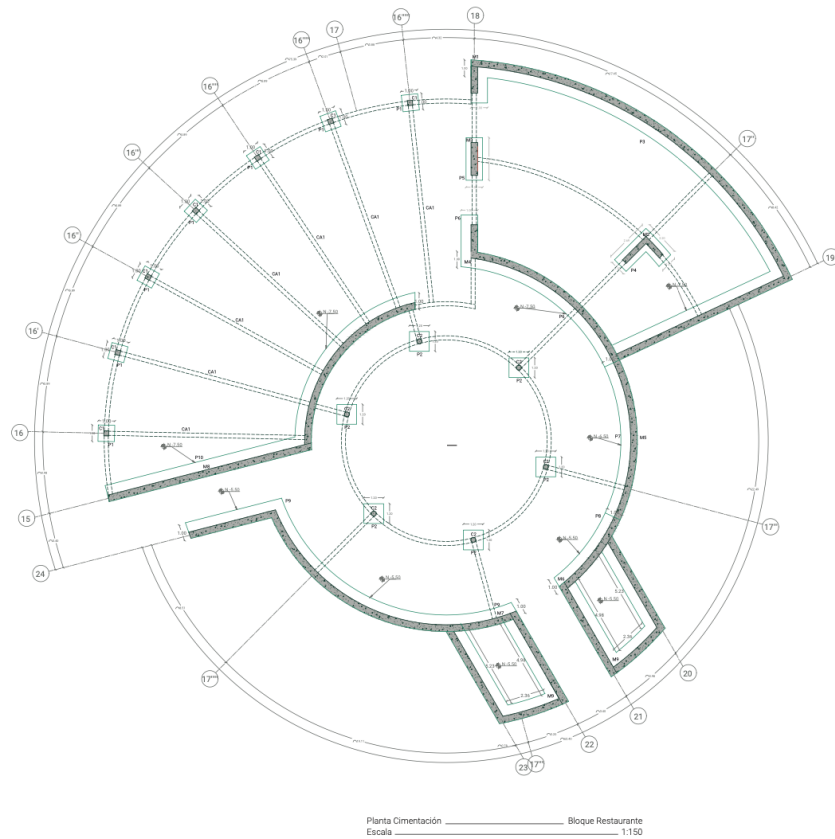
Planta de cimentación volumen restaurante (Elaboración propia)
